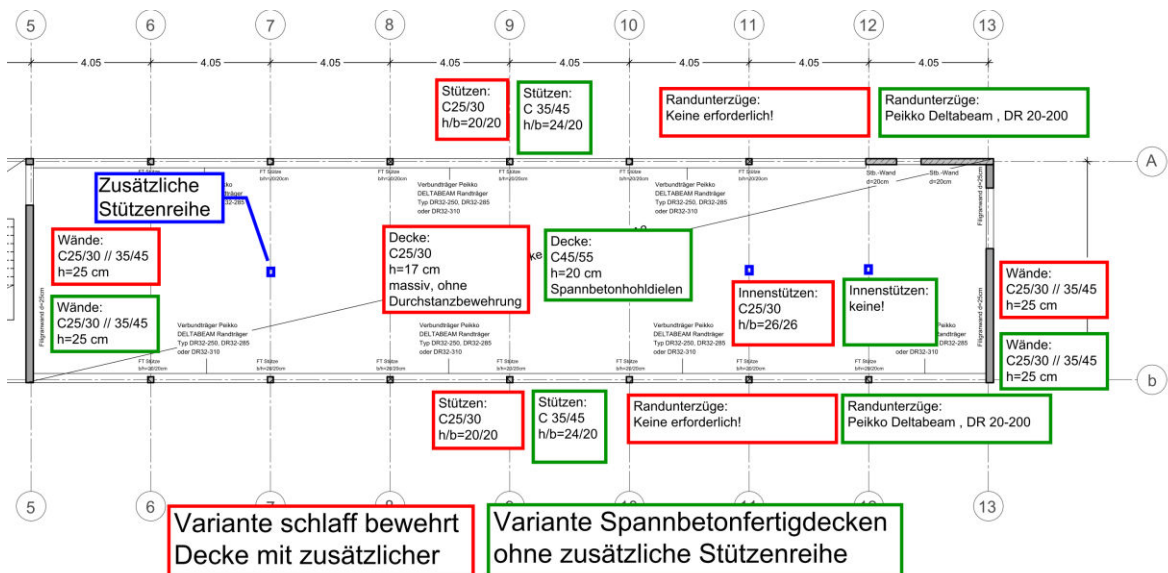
Bauteildimensionen im Vergleich bei Herstellung der schlaff bewehrten Decke über EG mit einer zusätzlichen Unterstützung
